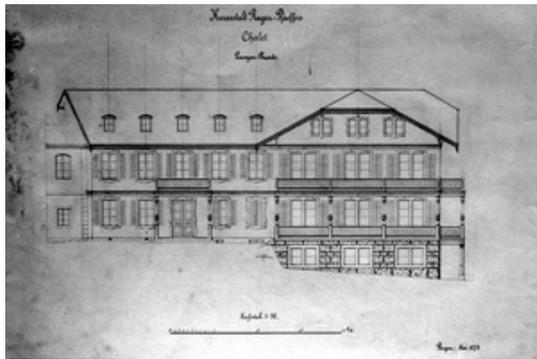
Bad Ragaz, Plan 39, Chalet Längsfassade, 1873
